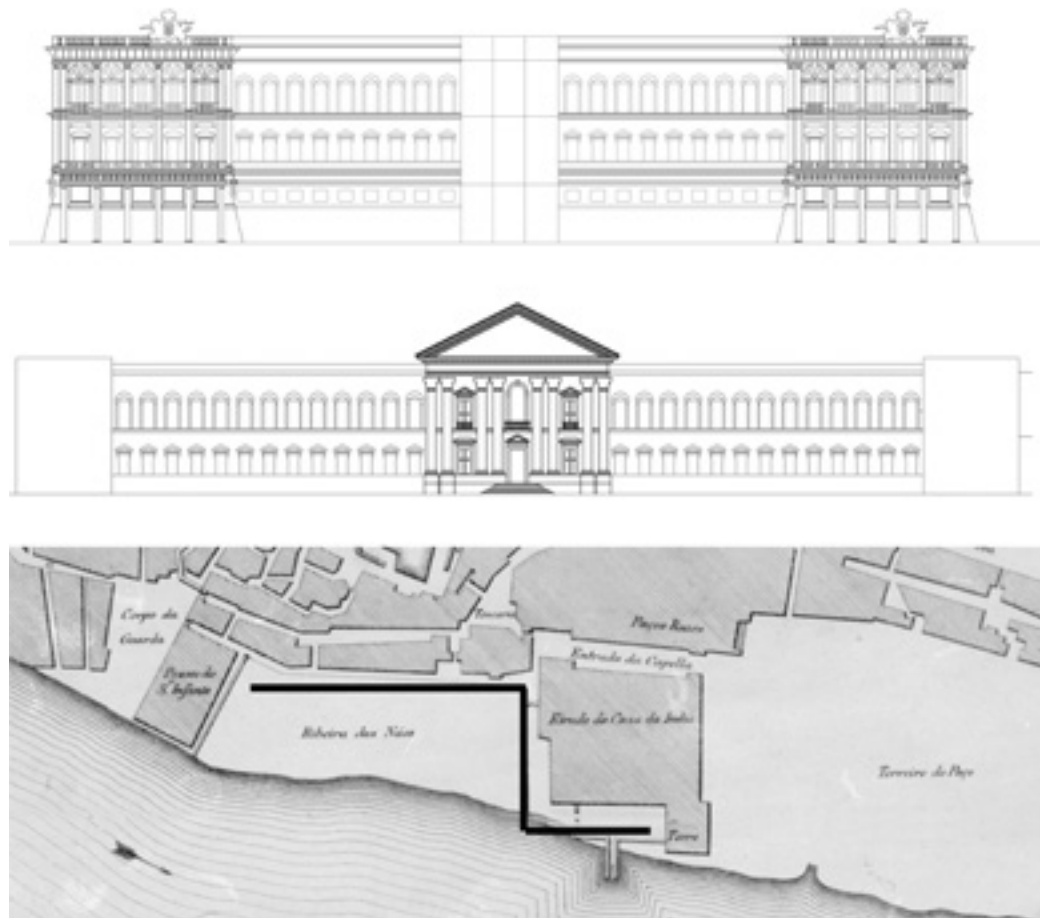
Ricostruzione e localizzazione del progetto di Filippo Juvarra per il Terreiro do Paço. La pianta è un dettaglio tratto da Nunes Tinoco, *Planta de Lisboa, 1650*, Lisboa, Biblioteca Nacional. Elaborazione dell’autore
